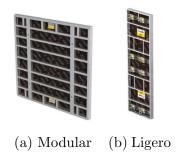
Moldajes Modular y Ligero. Fuente: Moldaje para Muros y Losas, ULMA.
